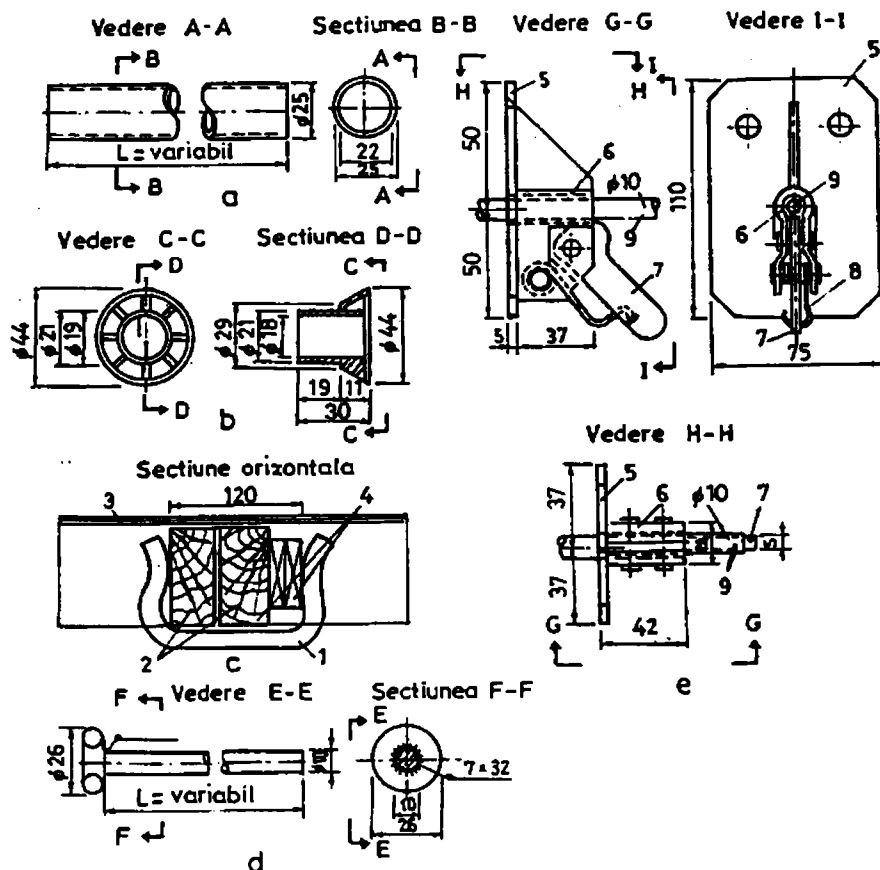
Elemente auxiliare pentru asamblarea cofrajelor:
